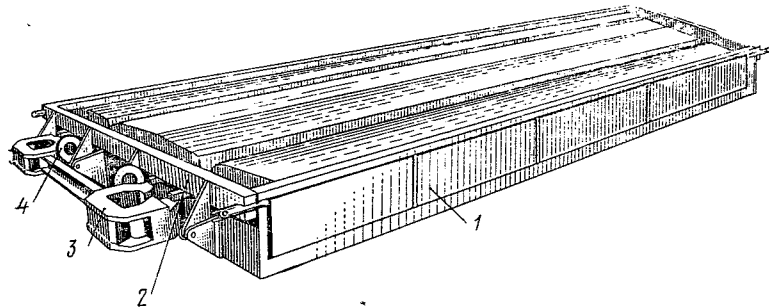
Форма для изготовления плит перекрытий типа «двойное Т»:
